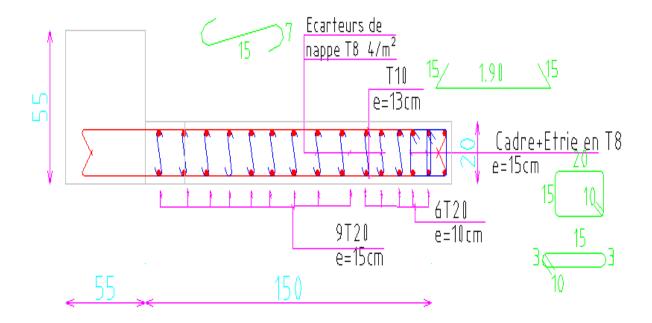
Schémas de ferraillage de voile v1 type1 zone1.
